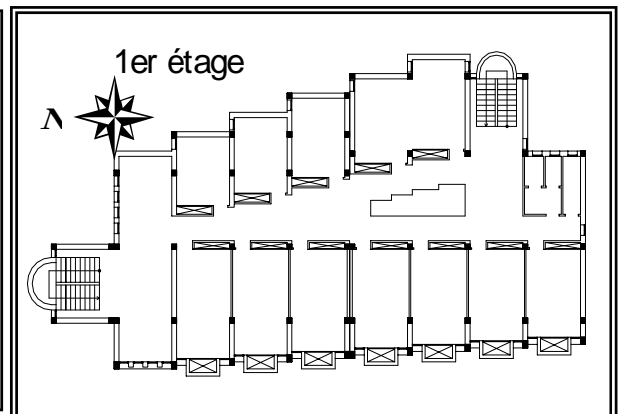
Bâtiment de la direction des affaires générales "DRAG", vue sur la mezzanine et plan du 1^e étage.
